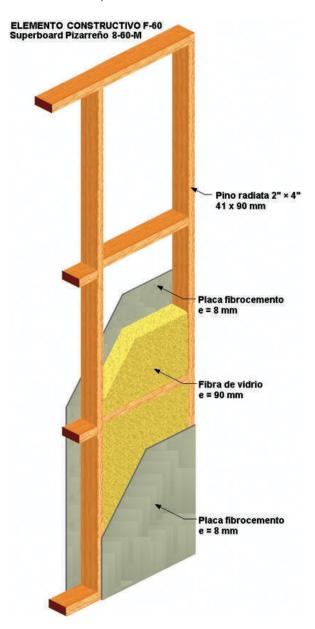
35: Elemento constructivo F-60 Superboard Pizarreño 8-60-M.
